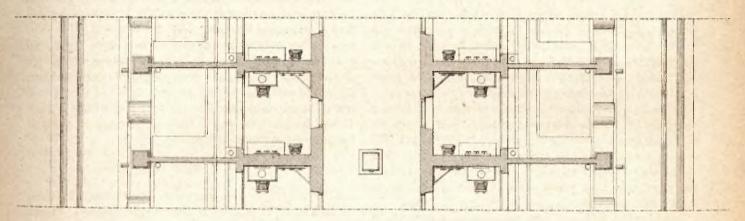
Sezione di un corridoio fiancheggiato dai camerini da bagno. Scala di 1 a 100.
